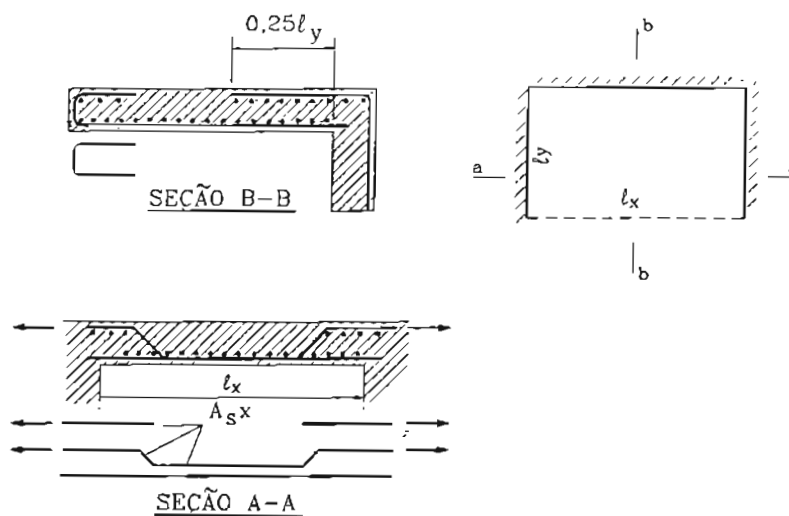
Detalhe de engastamento da laje na viga
